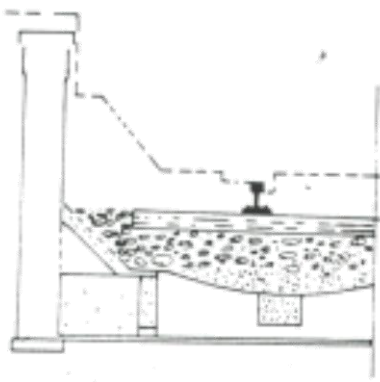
สะพานบวราง (Rail Girder)
